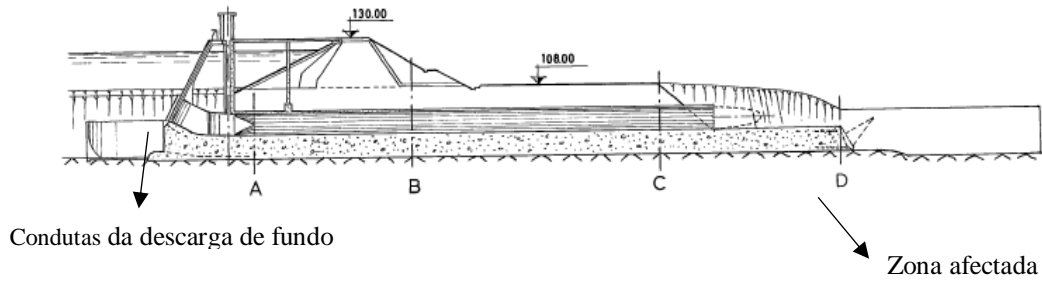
Perfil longitudinal da zona da descarga de fundo (LNEC, 2010 a)).
